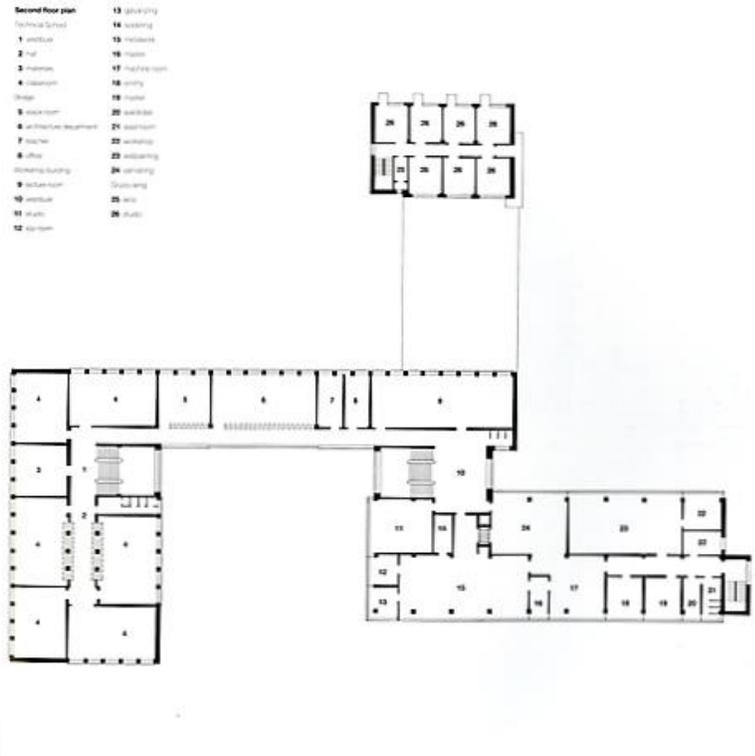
, Planta arquitectónica Nivel 4 de la Bauhaus. Plataforma Arquitectura. 2018
